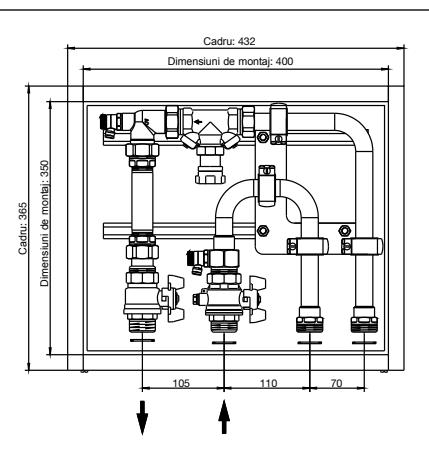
Dimensiuni pentru racordarea în partea inferioară
